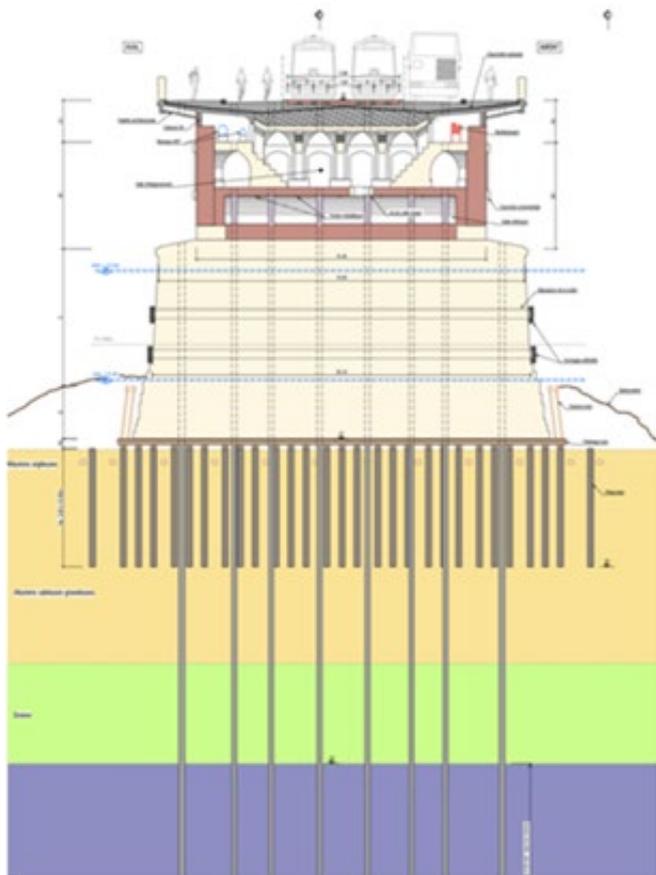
Illustration du renforcement par micropieux du Pont de Pierre à Bordeaux : micropieux à réaliser depuis le tablier au travers des maçonneries, scellés sur toute la hauteur des maçonnerie et ancrés dans les marnes au-delà des couches alluvionnaires (document d'appel d'offre public)
